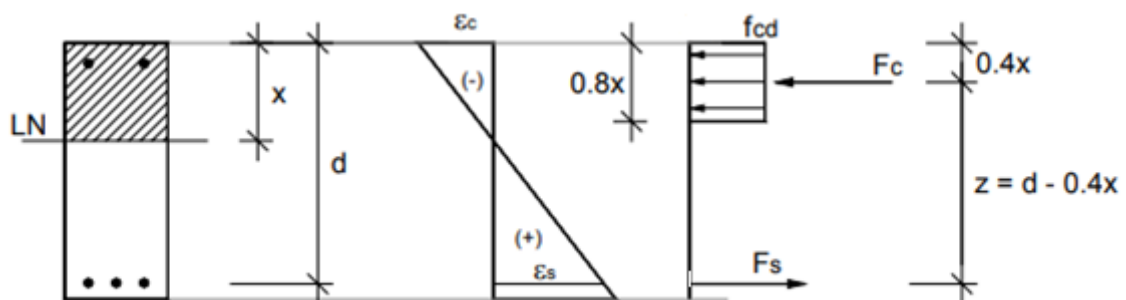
Diagrama retangular simplificado (IST, Betão Armado e Pré-Esforçado I)
